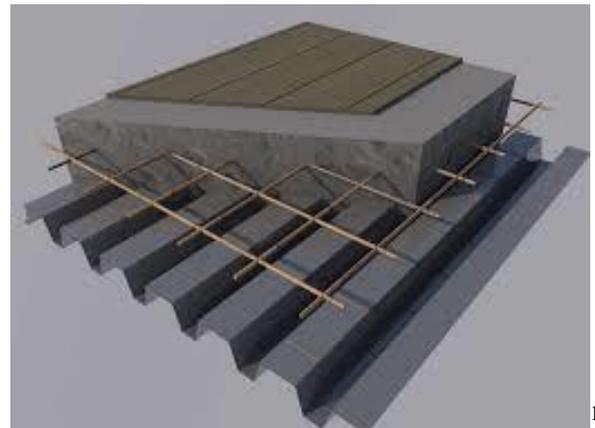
assemblage poutre alvéolaire avec plancher collaborant
